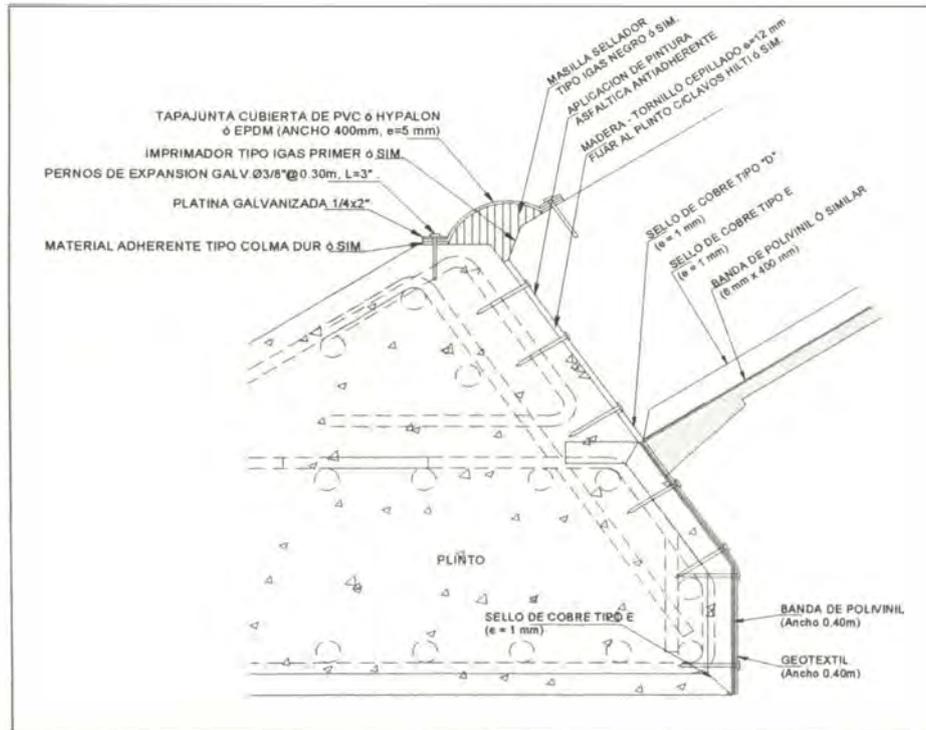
Detalle de la junta perimetral entre la losa de concreto y el plinto de la presa.
